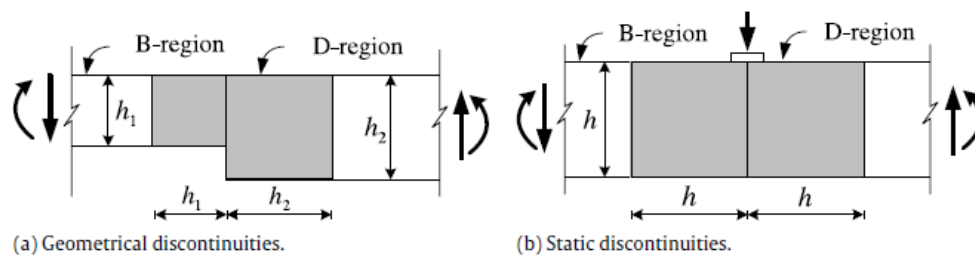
APRESENTAÇÃO DOS TIPOS DE REGIÕES B E D EM VIGAS DE CONCRETO ARMADO.
